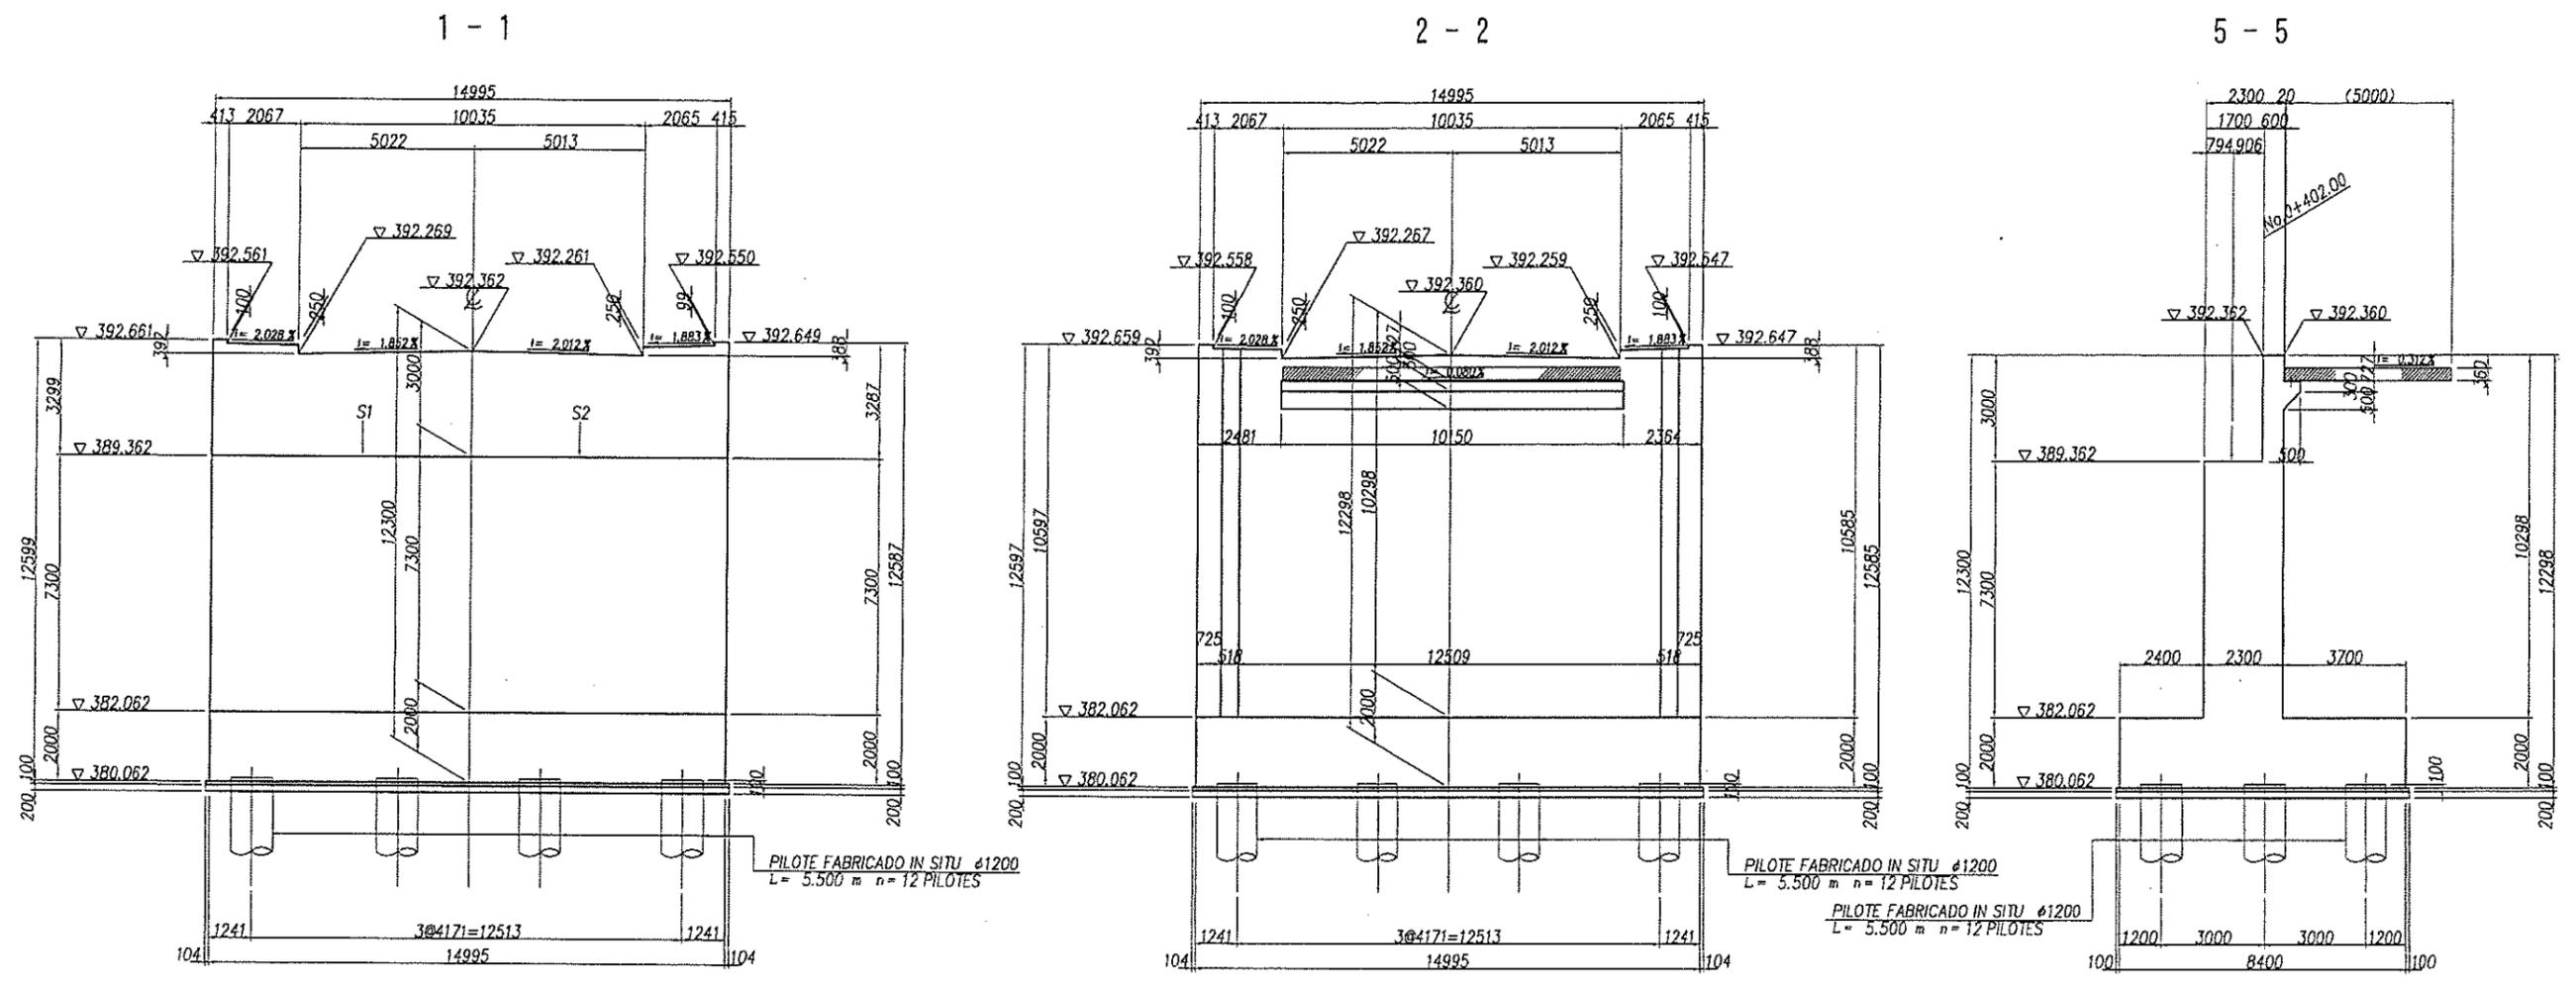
Plano Estructural de La Base del Puente A2 (1)
